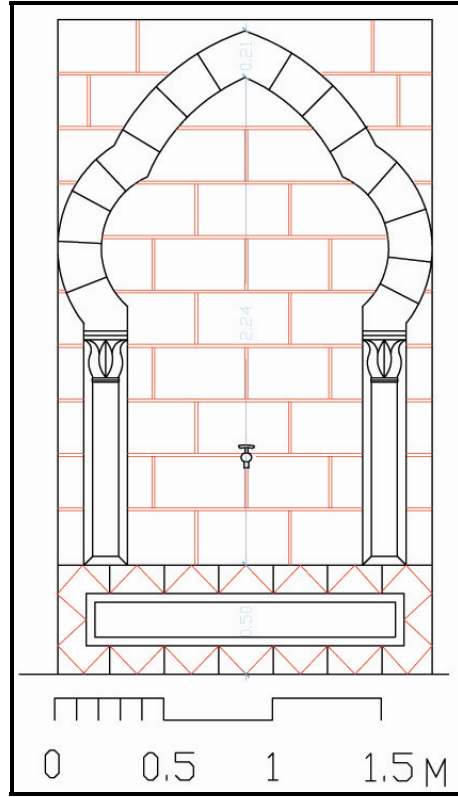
مسقط أفقي لسبيل عين جديدة
